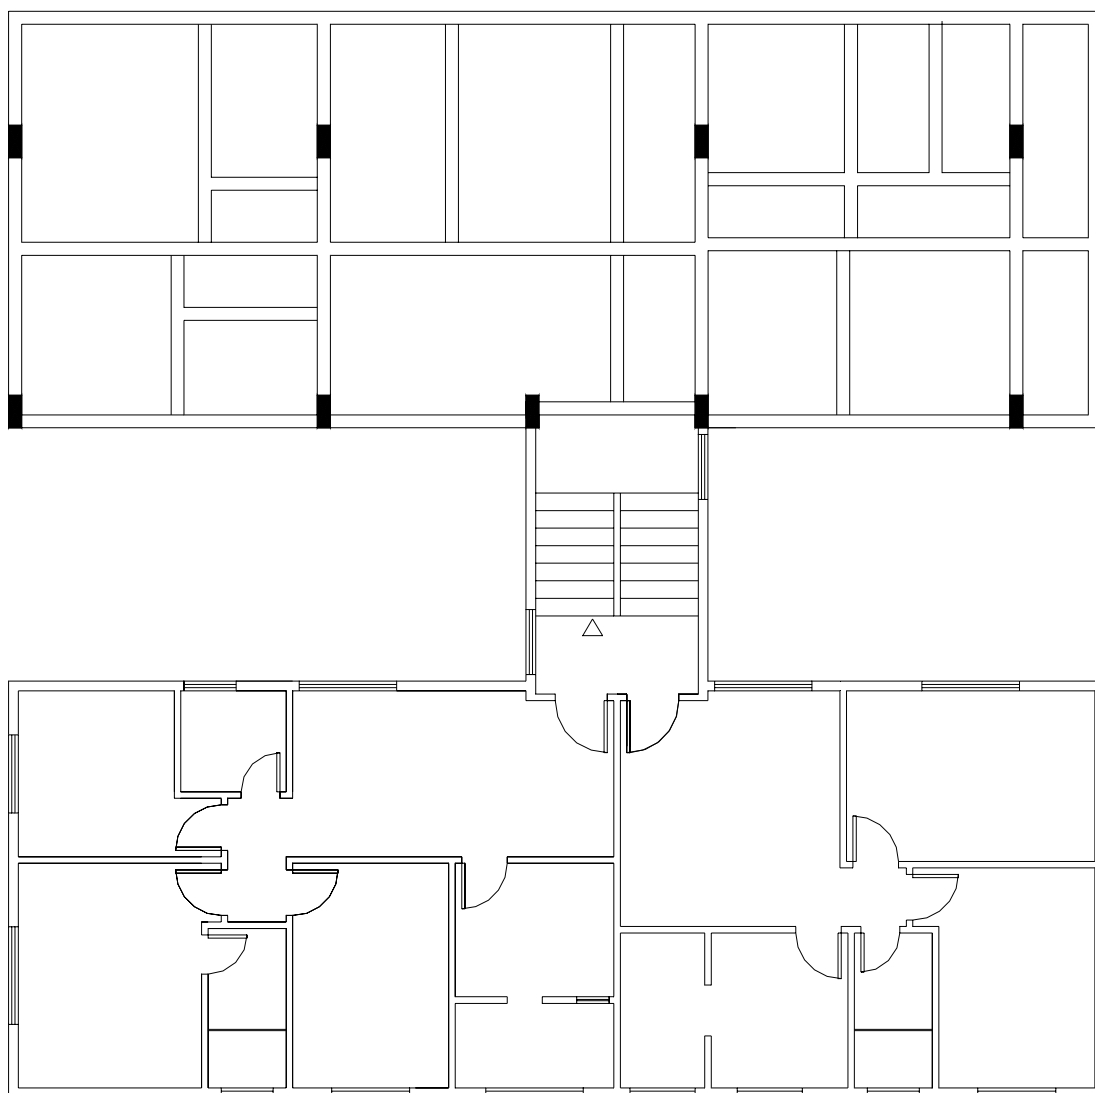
Residencial “S” – Segunda solução de vigamento do pilotis
